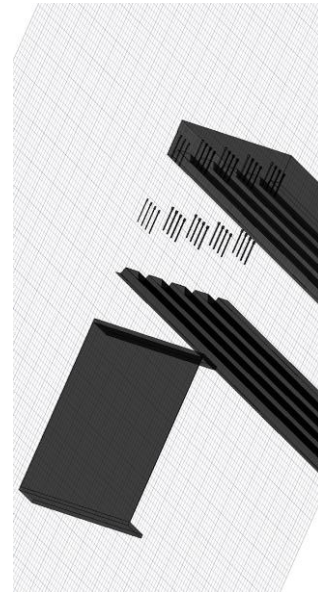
Элементы модели сталежелезобетонного перекрытия по профилированному настилу с гибкими упорами. / Elements of the model of composite reinforced concrete slab along profiled flooring with flexible stops.
